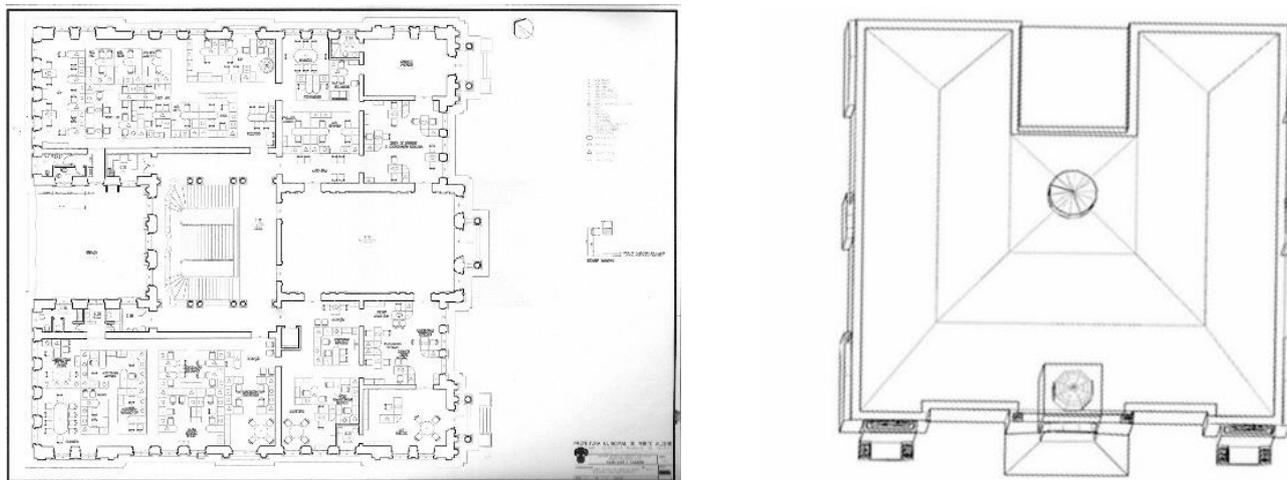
Planta baixa do segundo andar Vista superior da volumetria em U do Paço dos Açorianos
